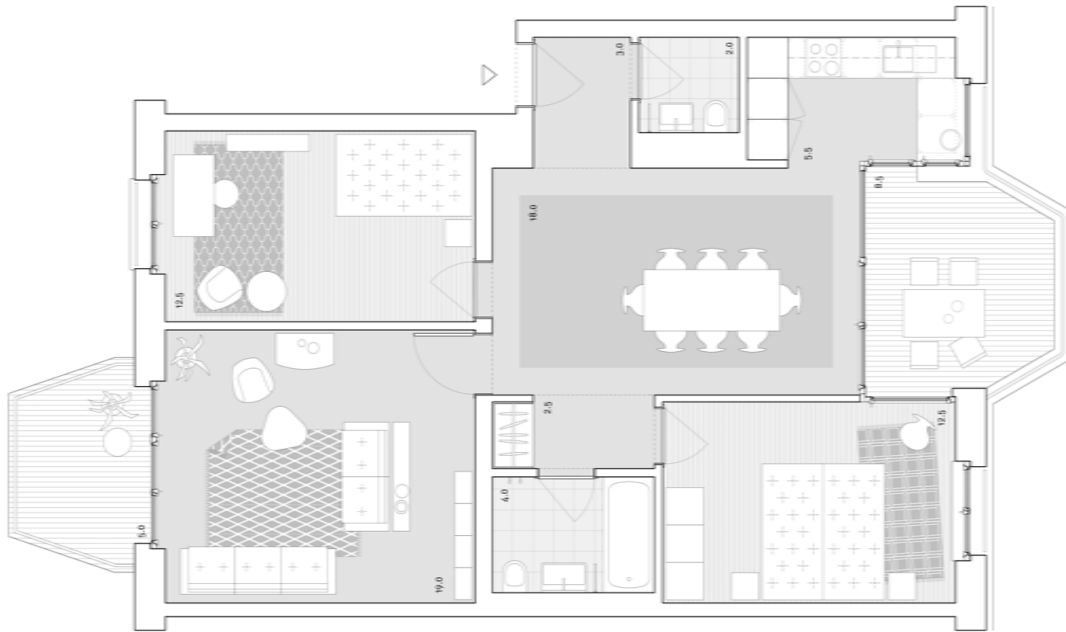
Penelope: Wohnungsgrundriss 3.5-Zimmer-Whg.
